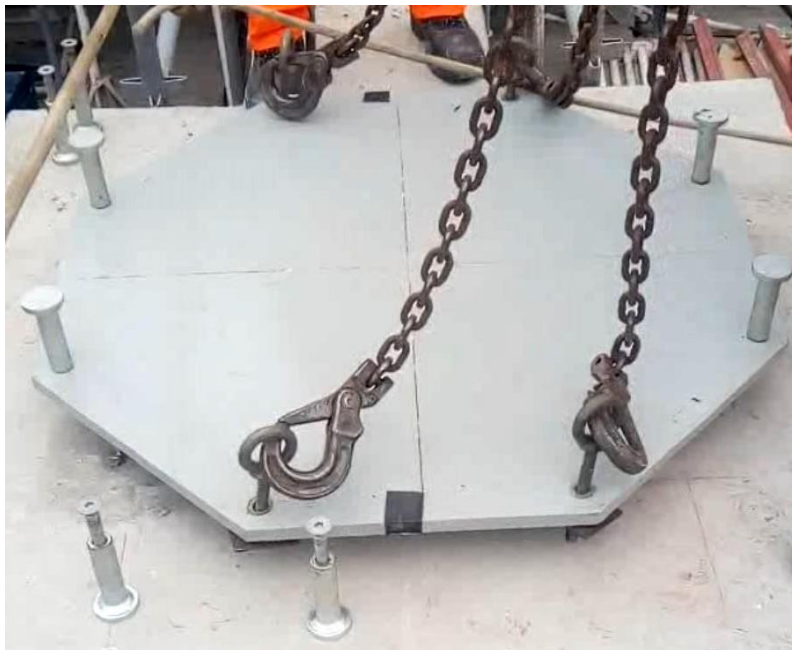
“Colocación de la plancha superior de deslizamiento de los deslizadores sobre el disco inferior de apoyo”
